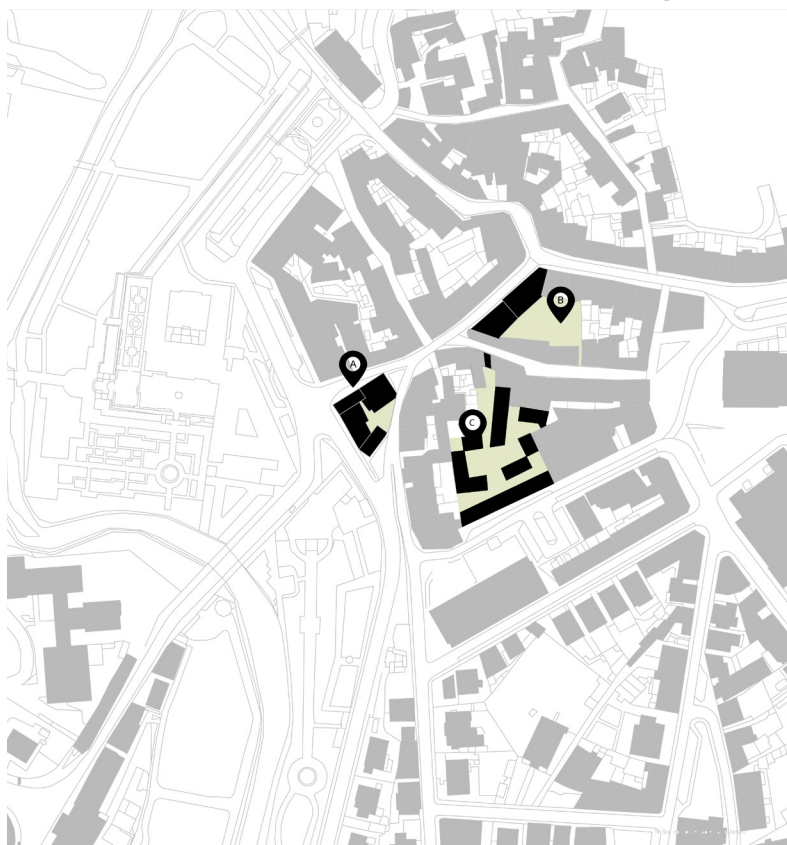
| Planta de implantação do projecto. Imagem de autor.
